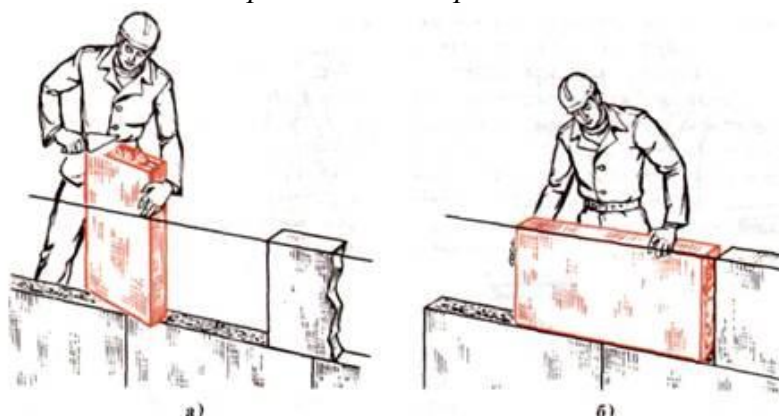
Кладка перегородок из гипсовых плит: а — нанесение раствора на боковую грань плиты б — установка плиты
